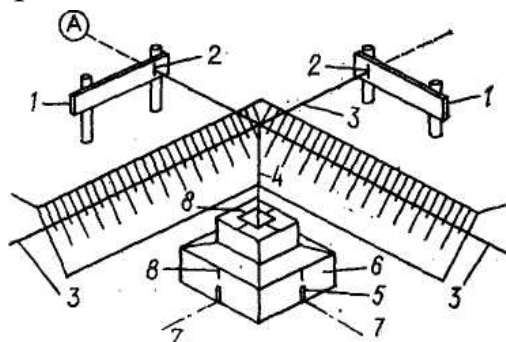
Разбивка осей фундамента под колонну:
